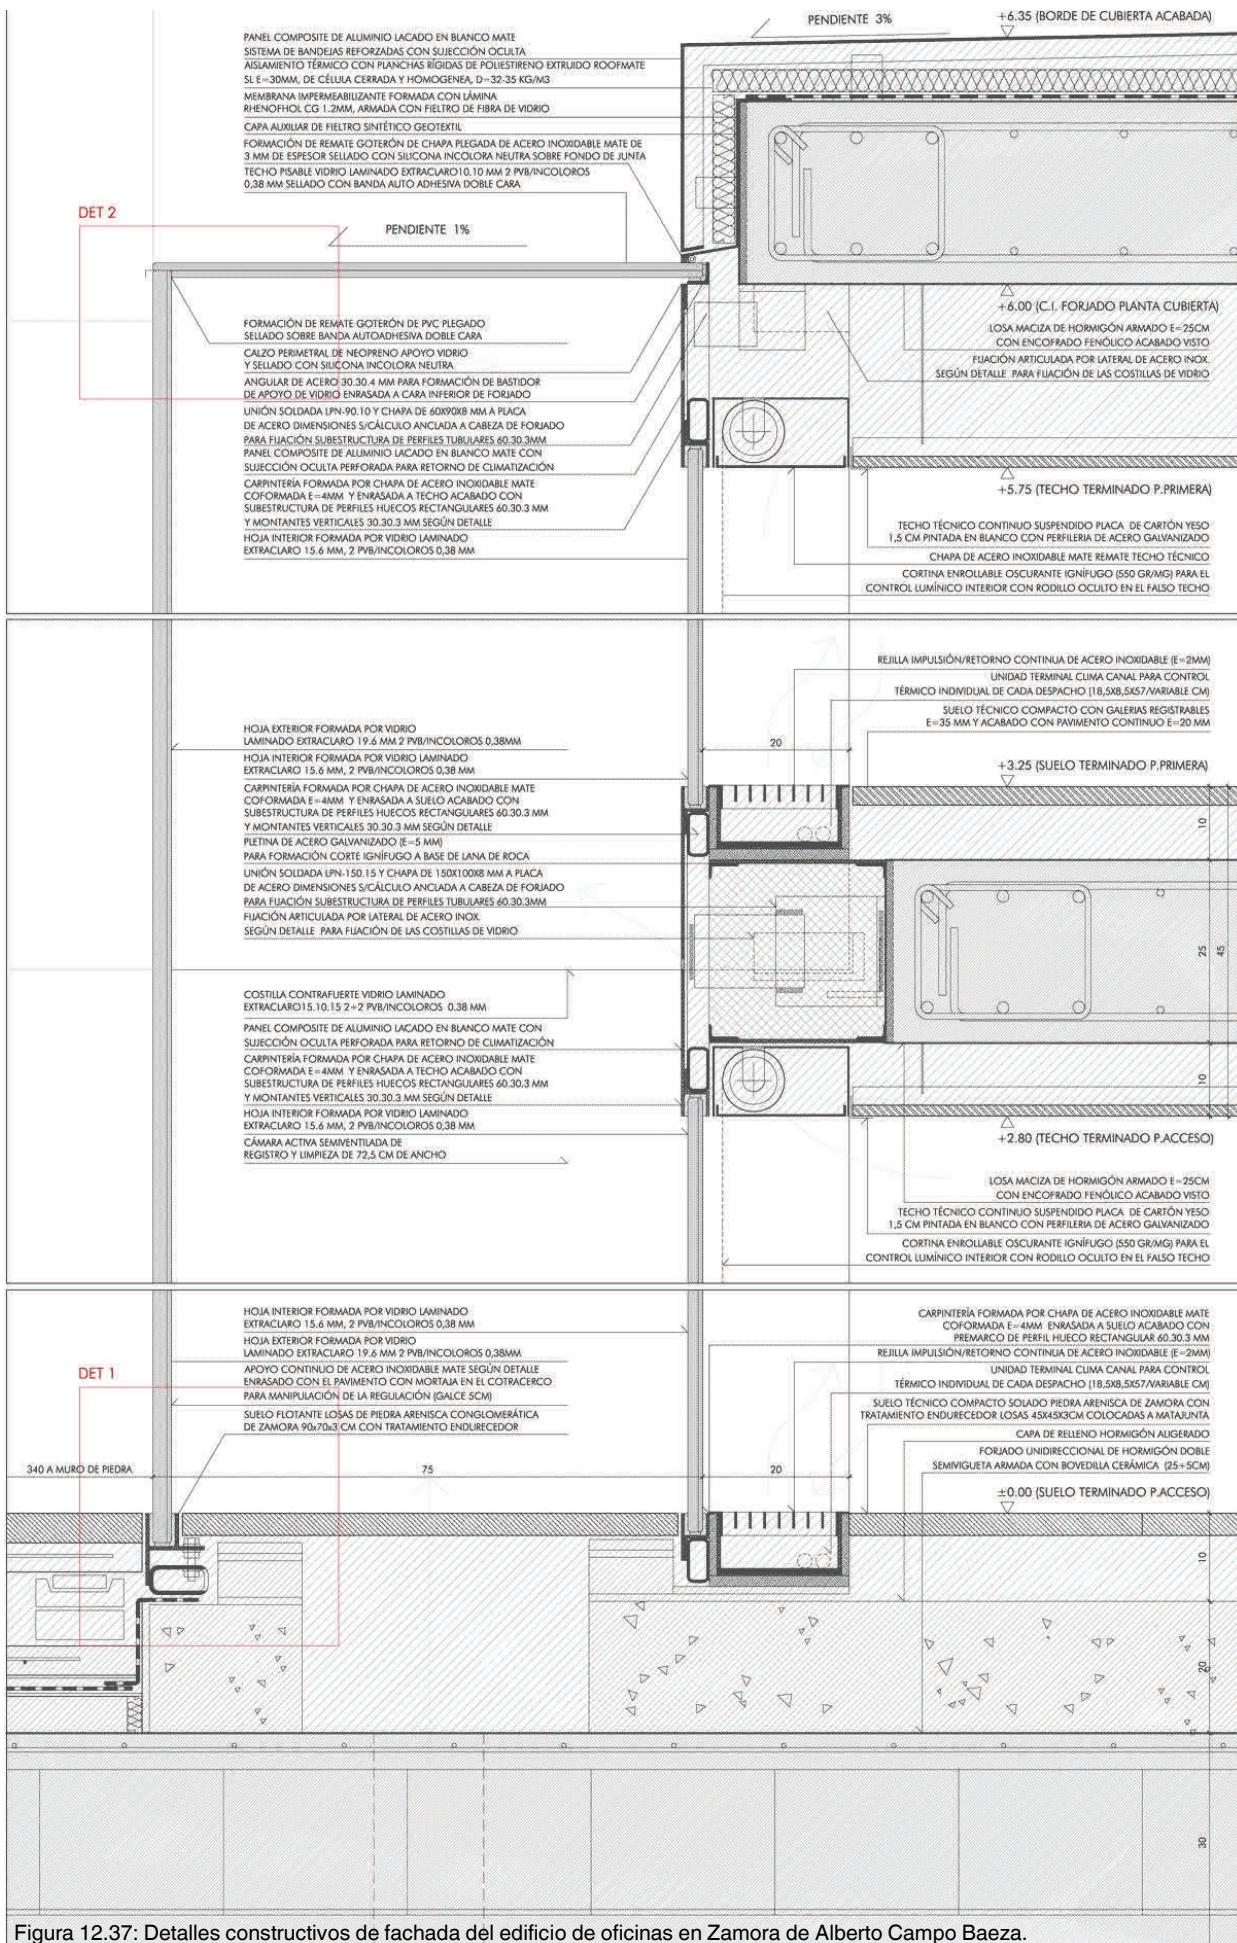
Detalles constructivos de fachada del edificio de oficinas en Zamora de Alberto Campo Baeza.
